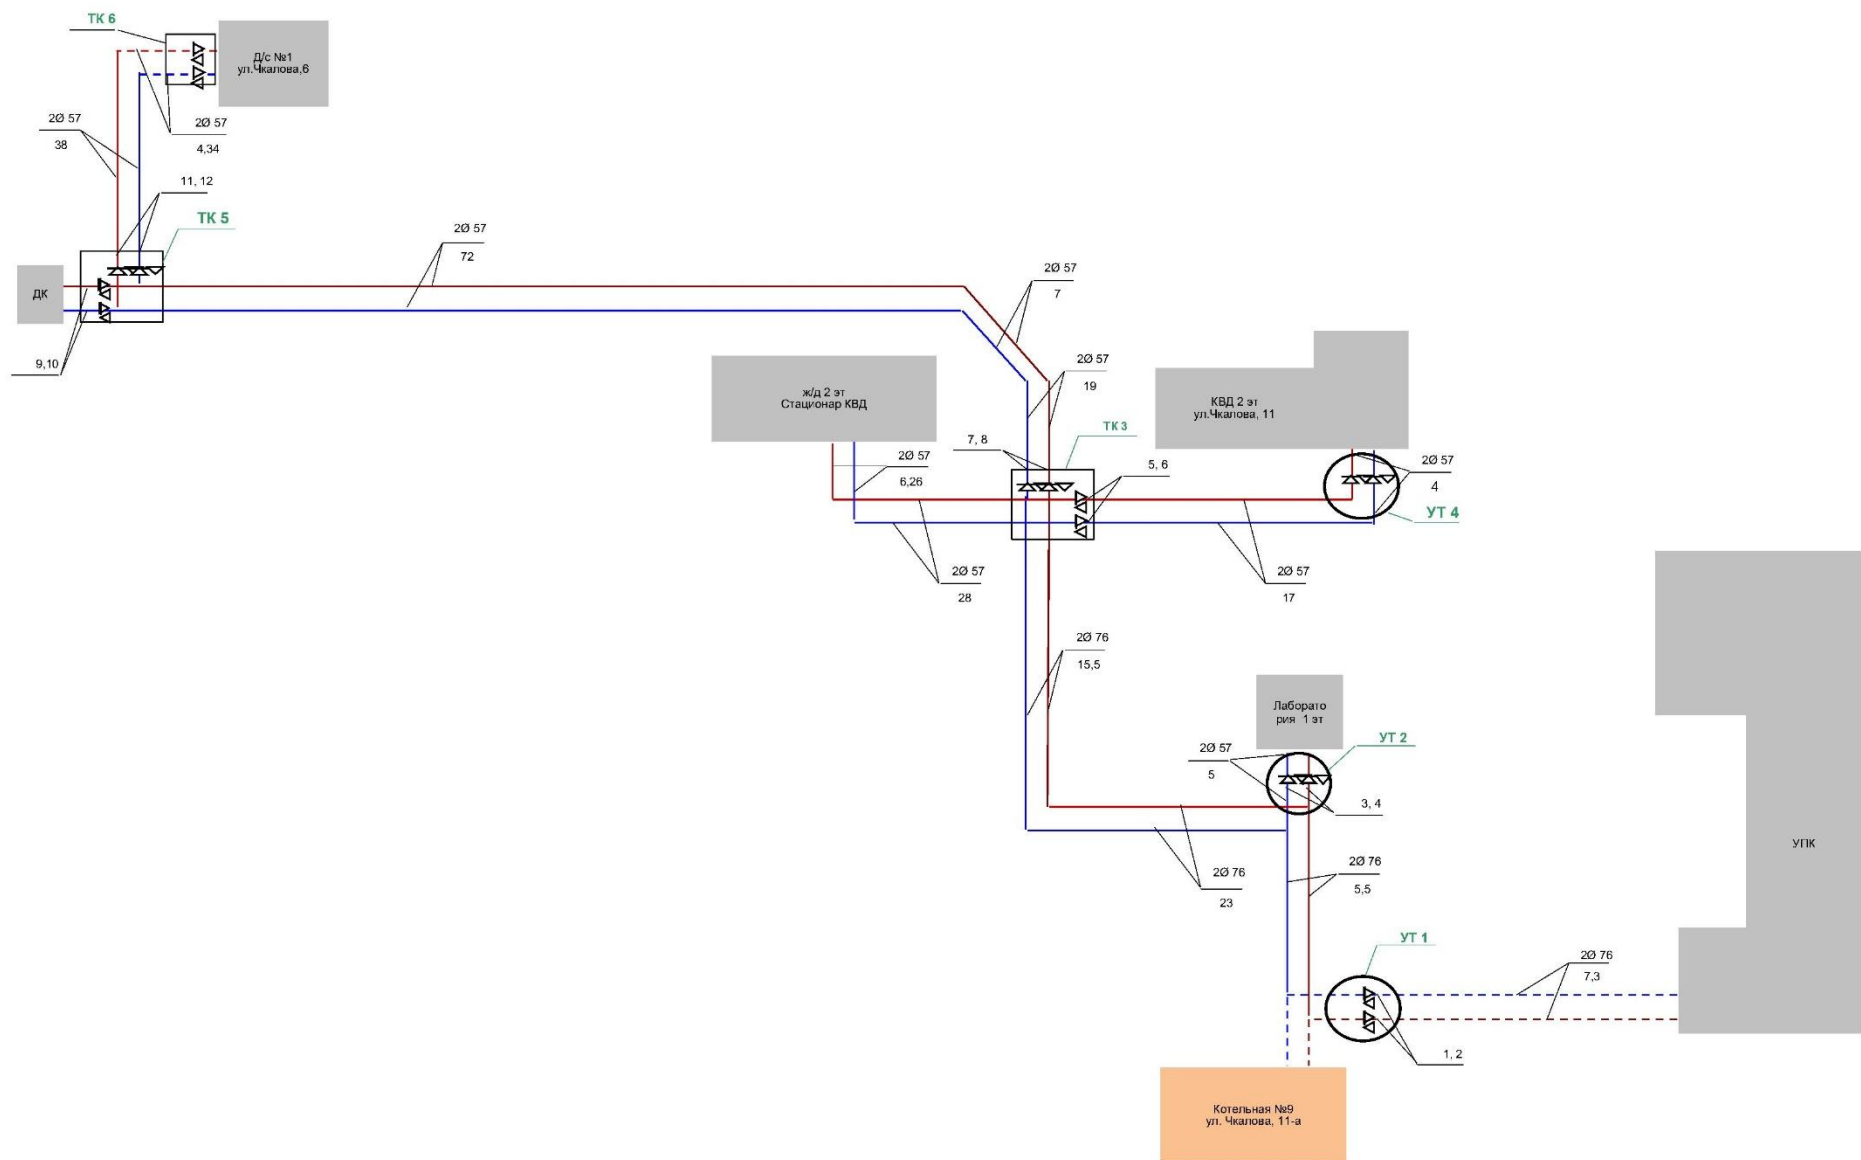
Схема тепловой сети от котельной №9 ул. Чкалова, 11-а
